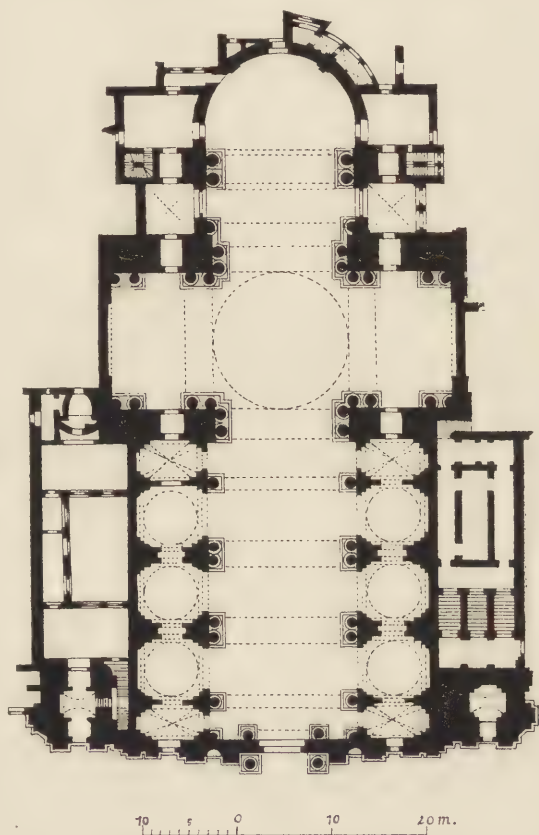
Theatinerkirche zu München. Grundriss.
